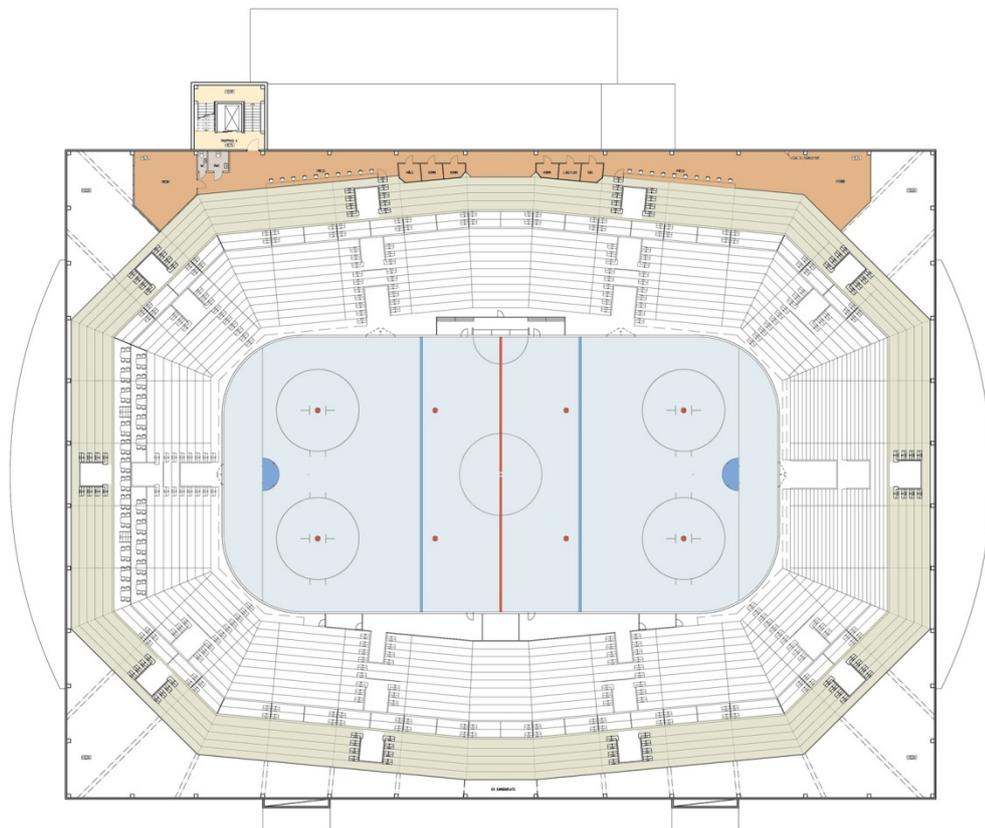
(oben): Grundriss des 2. Obergeschosses (das 1. beinhaltet nur einen Umgang und sanitäre Anlagen) mit den Logen für VIP-Gäste und Restaurantbereichen. (Quelle: Homepage der Arenabetreiber)
